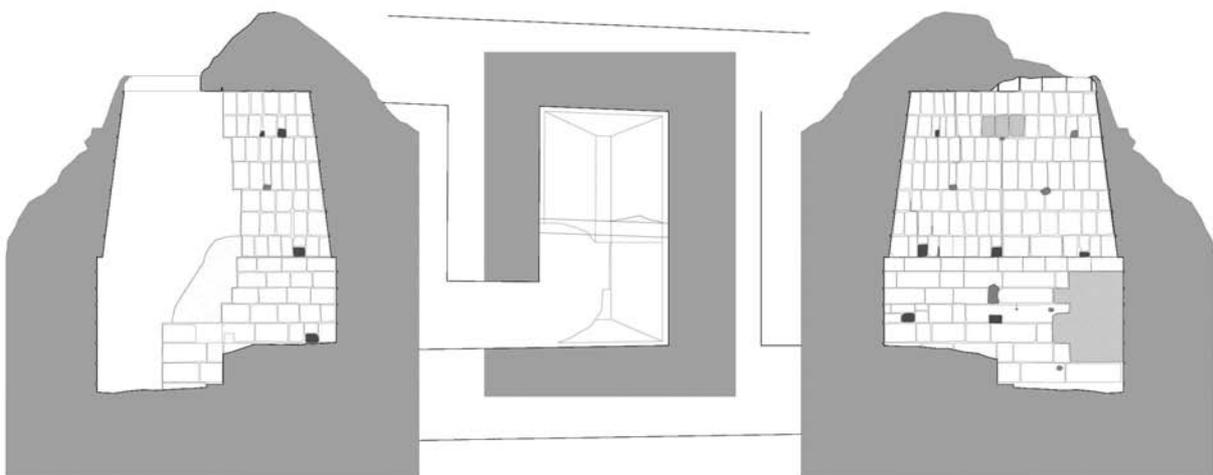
Plantas y secciones longitudinales del Cuarto 2
